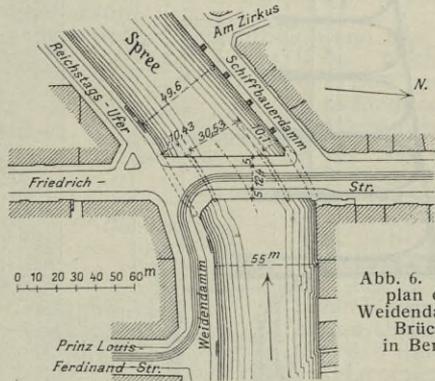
Lageplan der Weidendammer Brücke in Berlin.
